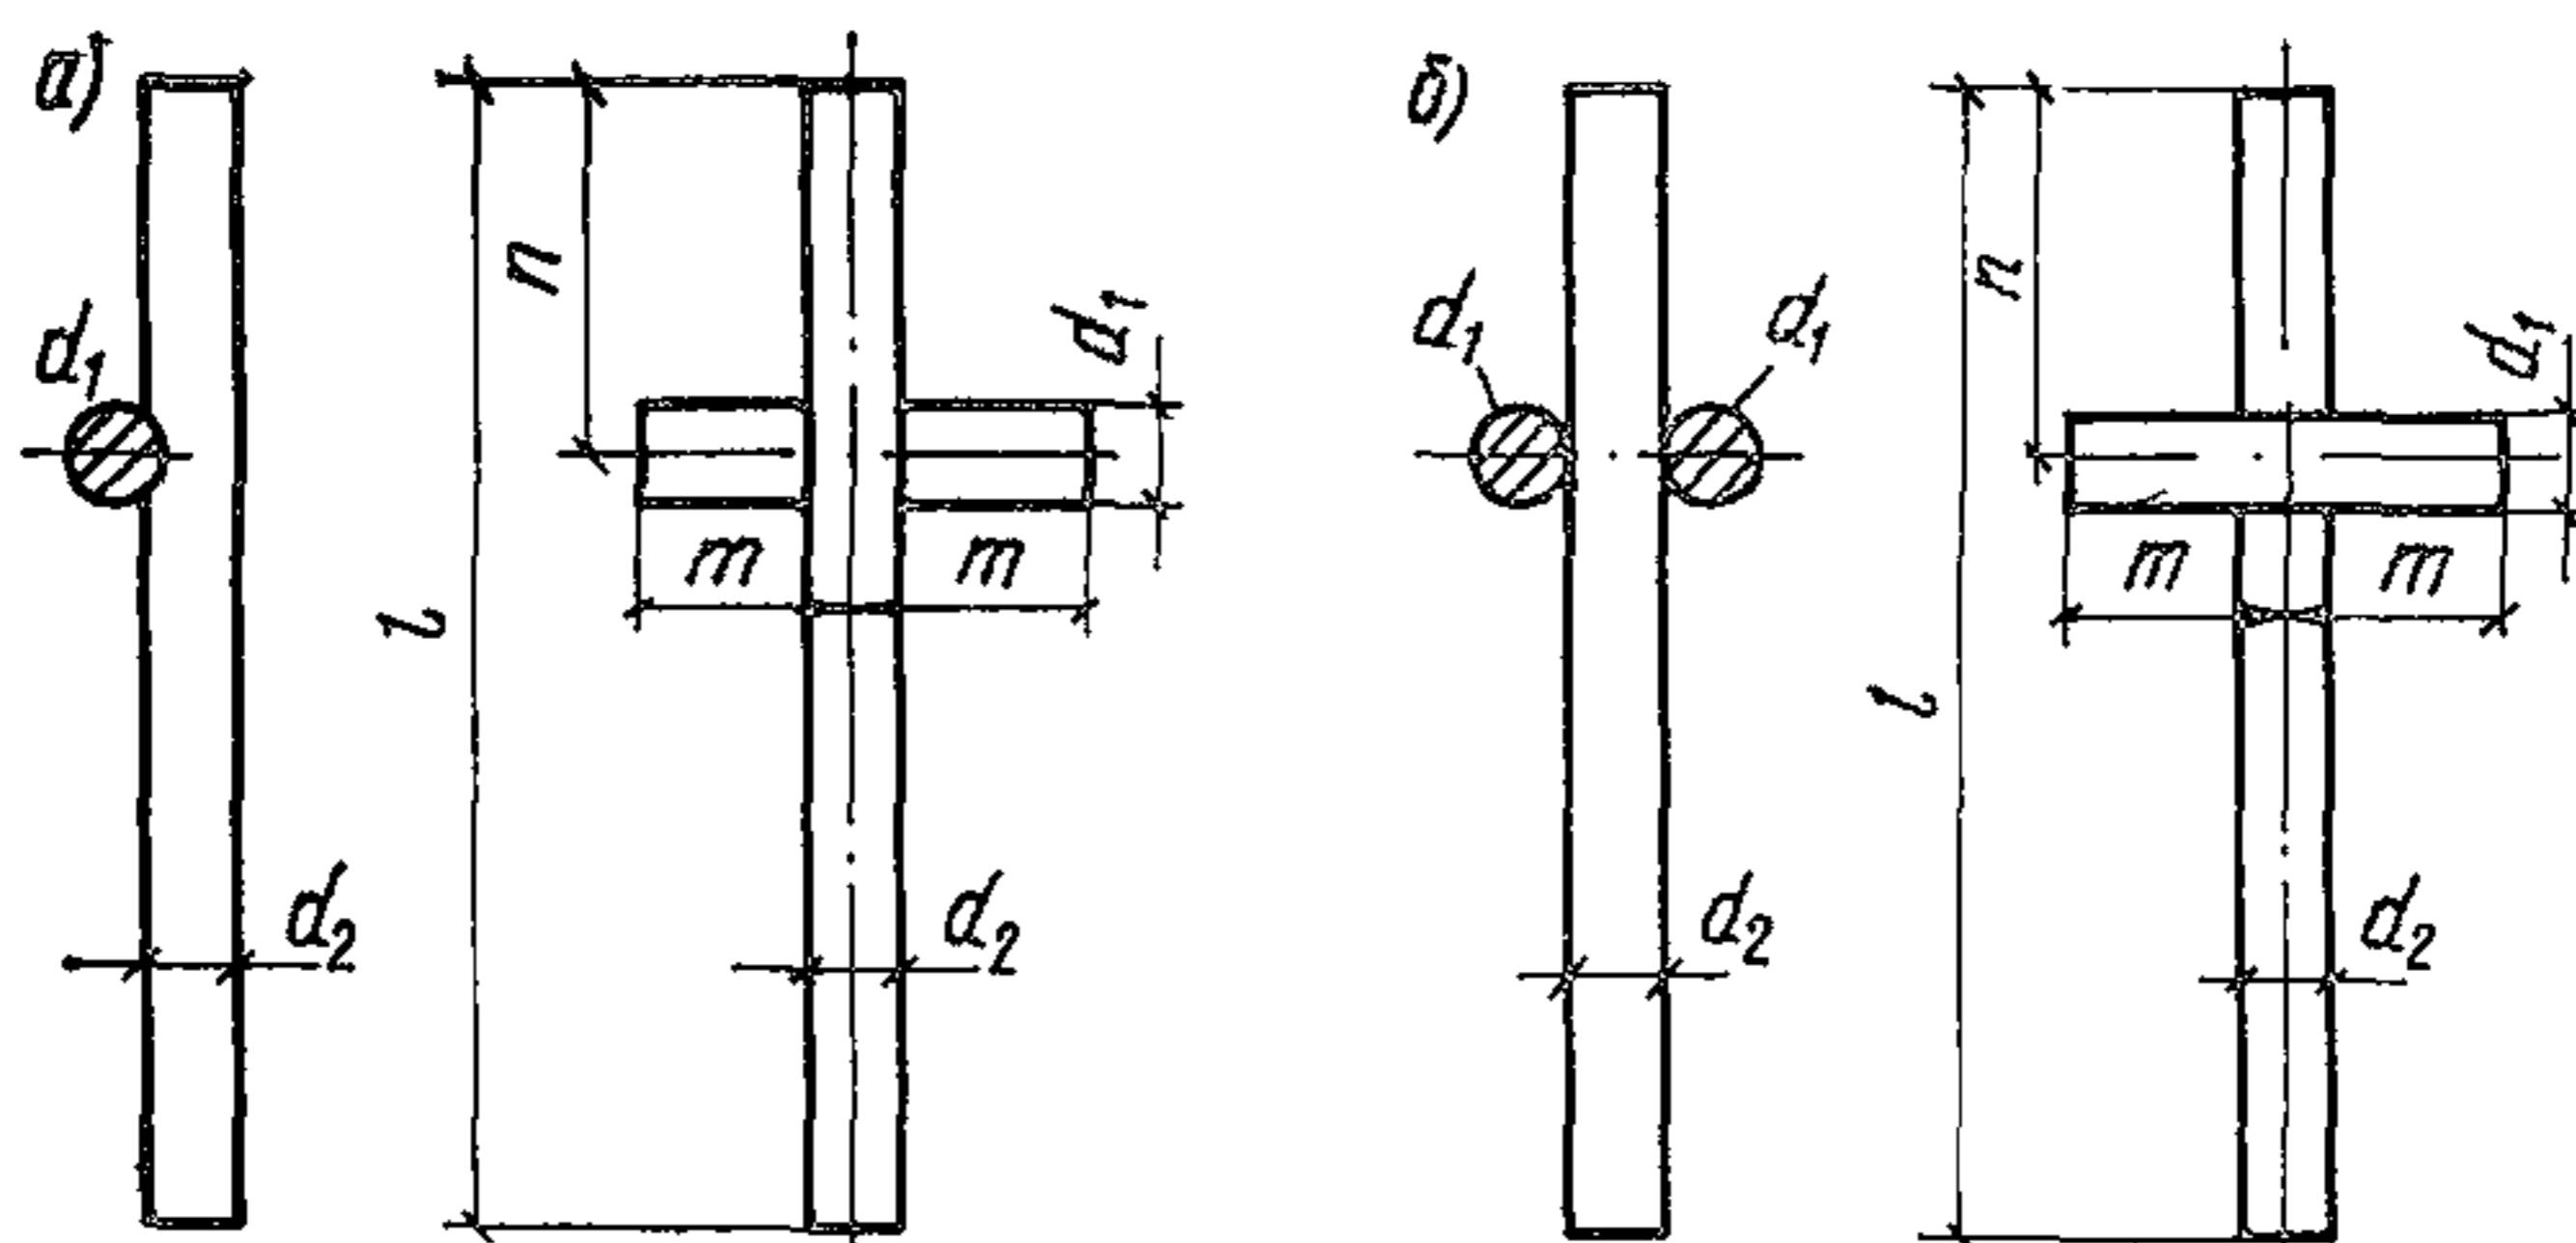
Контрольные образцы крестообразных сварных соединений арматуры для испытания на срез
